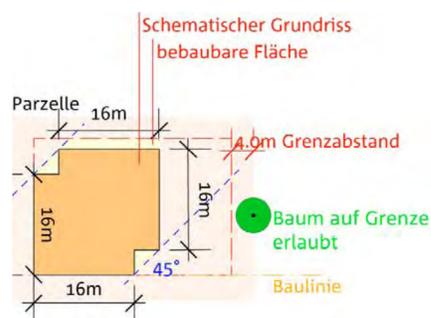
Prinzipschema für (Ersatz-)Neubauten in Abschnitten West und Mitte: Begrenzte Grundfläche, Gebäudehöhe: 5 Geschosse.
